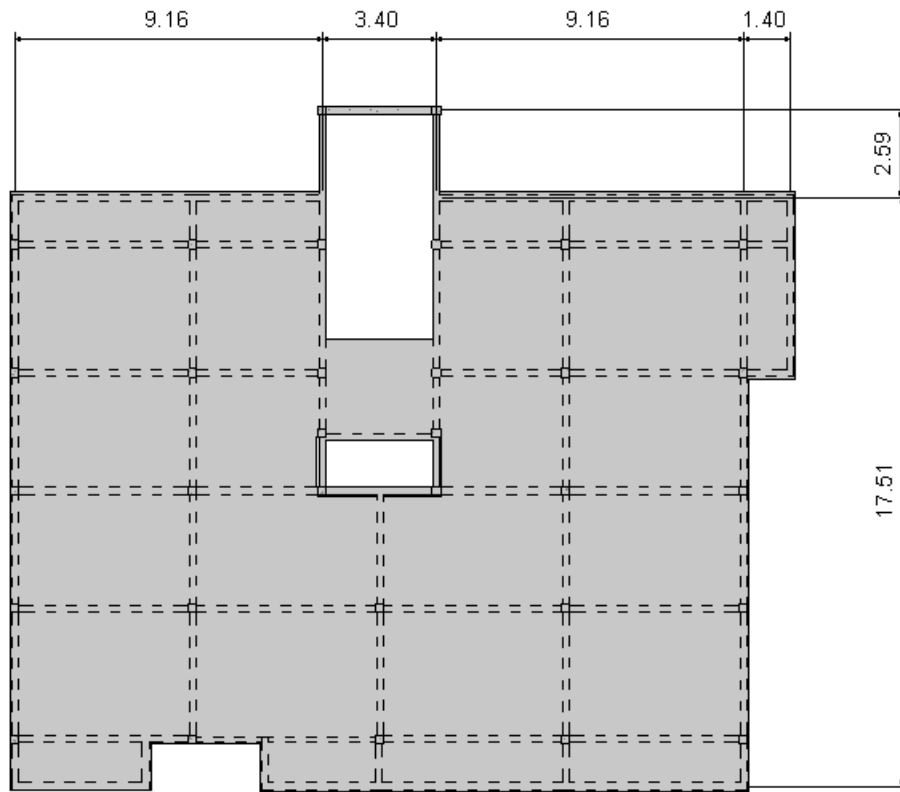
Planta estrutural do piso tipo da solução estrutural 2 (Revit).
